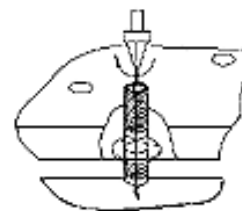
Вкрутите болты-стойки во втулку основанием вниз. Установите конструкцию на перекрытие.
